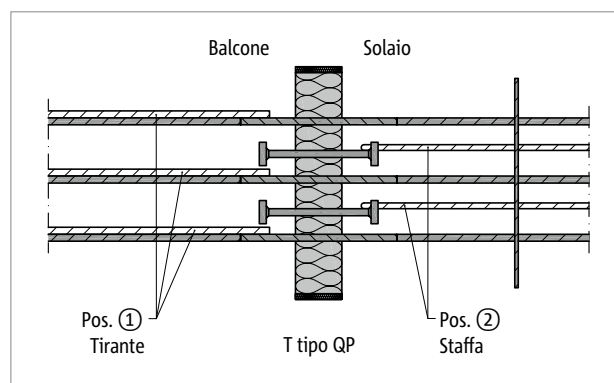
Schöck Isokorb® T tipo QP: dettaglio 1; raccordo armatura tirante
